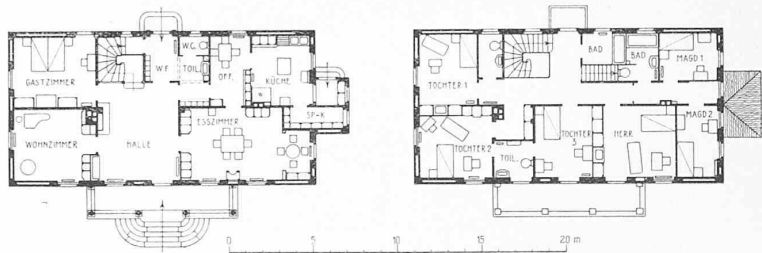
Grundrisse 1 : 400. — Architekt A. Ammann, Luzern.
